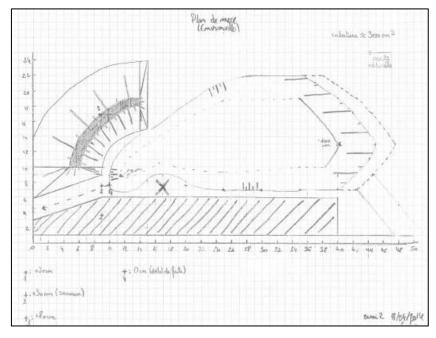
Plan de masse (source : Cyril LAMARRE)
